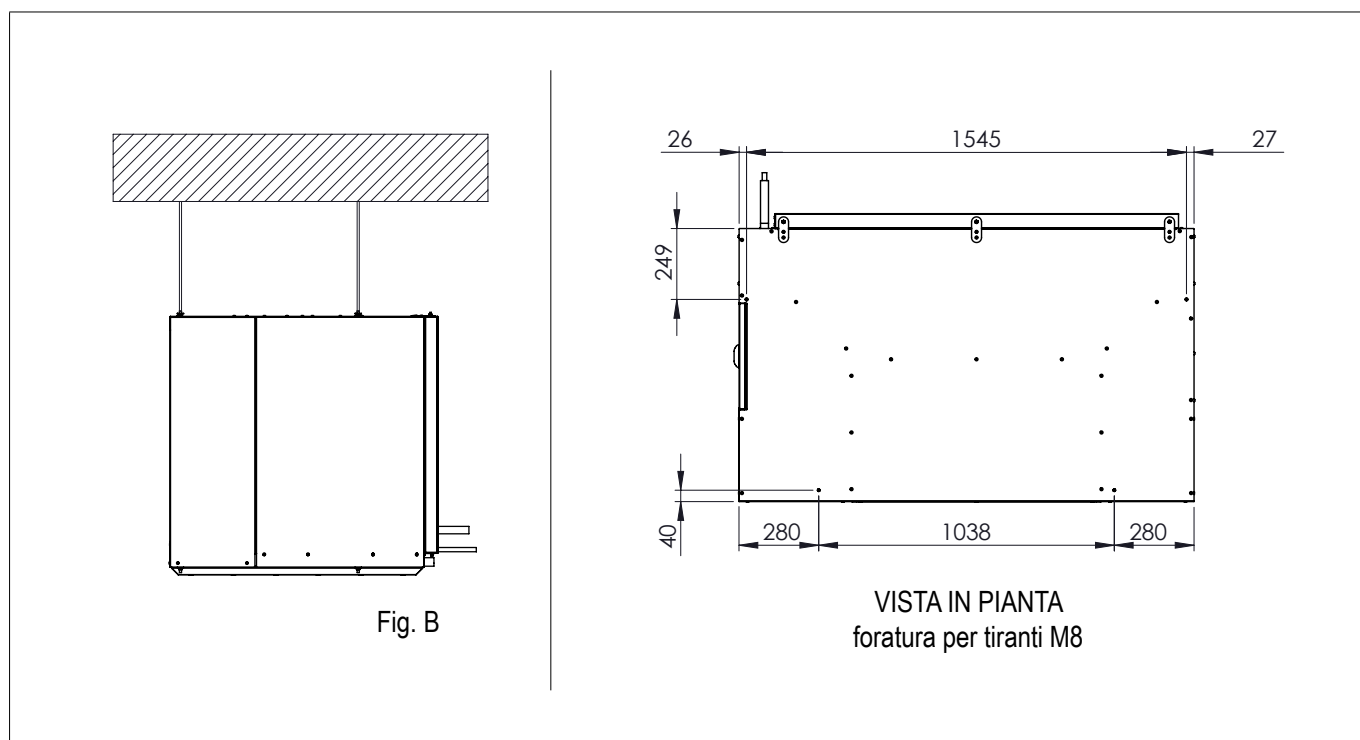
(Corretta installazione a soffitto dell'unità interna canalizzabile - Modalità 2)
